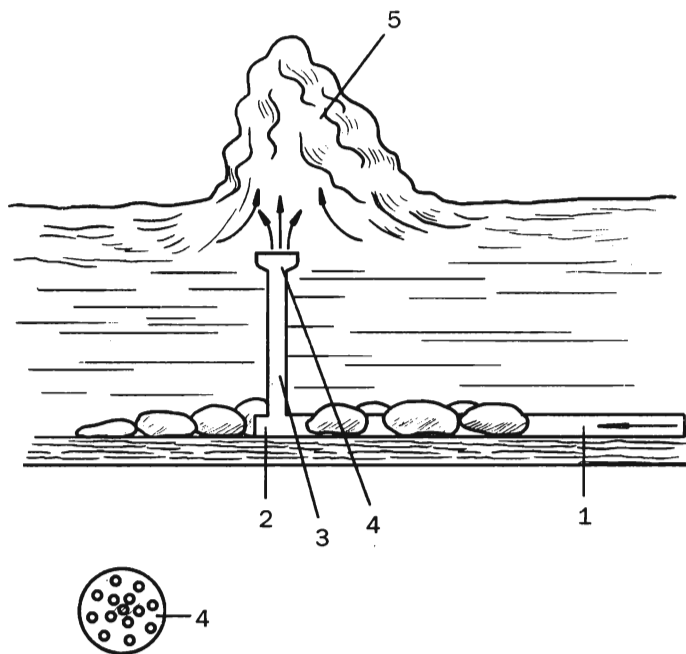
Высокий фонтан-ключ: 1 — подача воды от насоса; 2 — соединительная муфта; 3 — трубка вертикальной подачи напорной струи; 4 — насадка, расширяющая струю; 5 — столб воды
